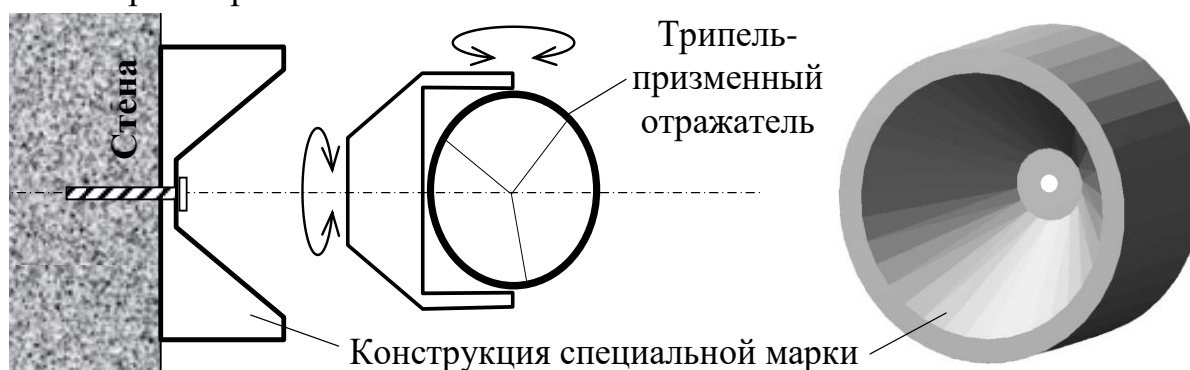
Внешний вид конструкции опорной и деформационной марки с быстрым креплением на ней призматического отражателя
